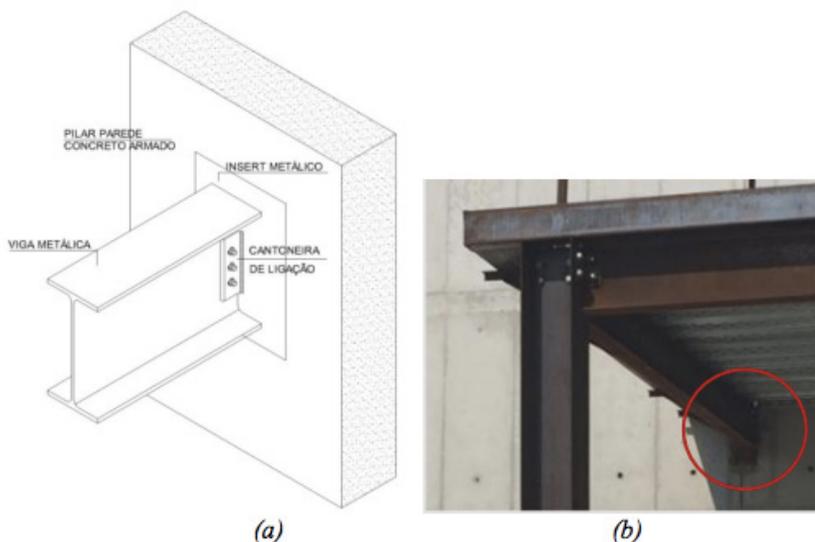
(a) Desenho explicativo da ligação viga metálica-concreto; (b) Viga fixada à estrutura de concreto.
